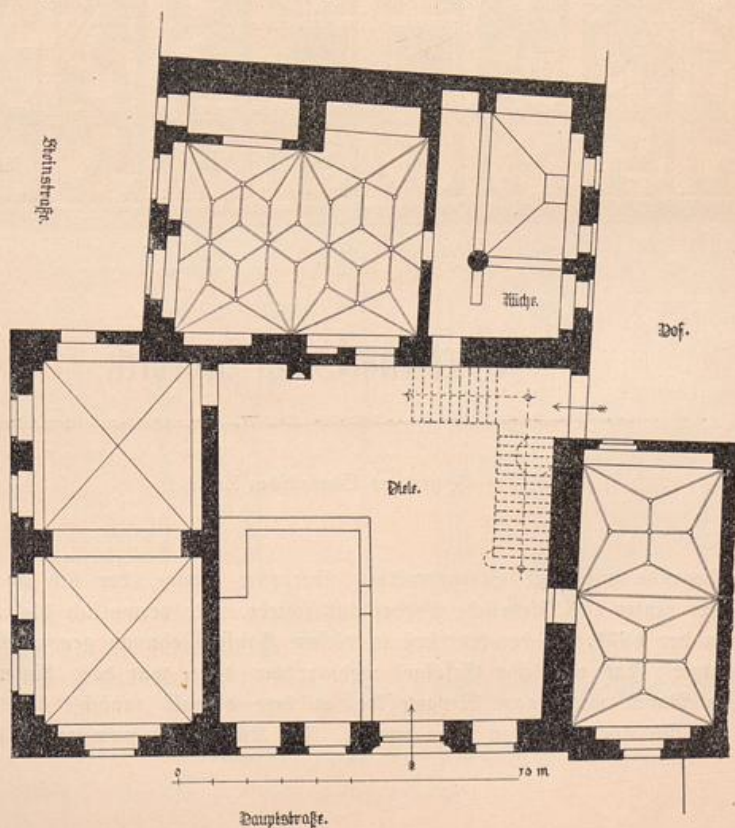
Erdgeschoßgrundriß des ehemaligen Hauses Storbek.
